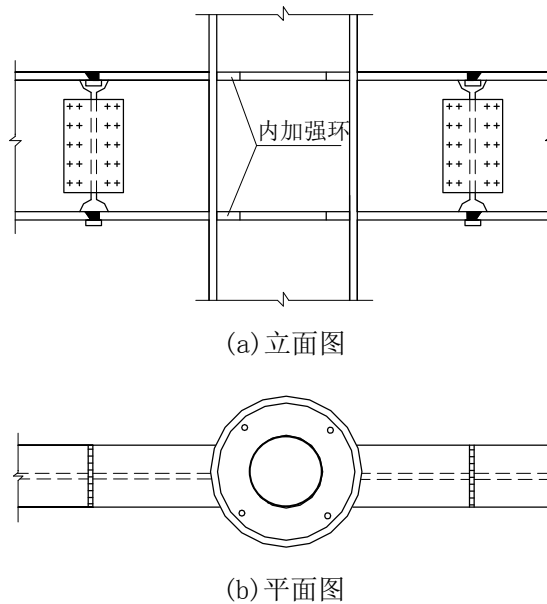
等截面悬臂钢梁与钢管混凝土柱采用内加强环连接构造示意
